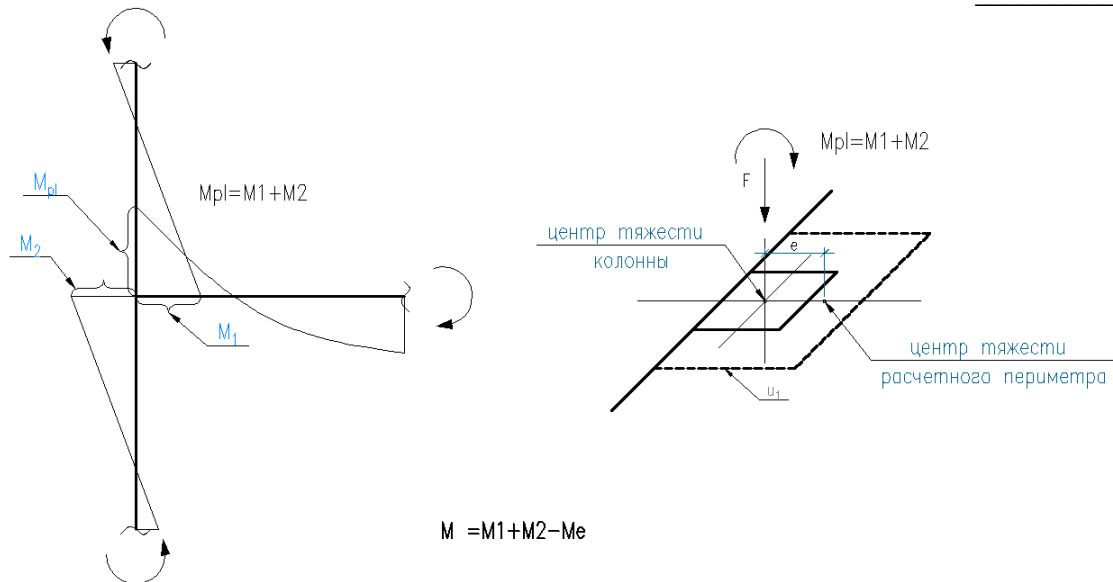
Расчетные усилия в плите перекрытия при опирании на крайние колонны.
